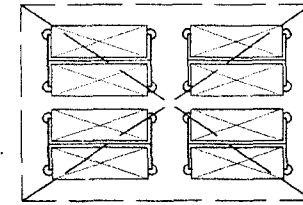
Вариант размещения стеллажей (этажерок) под вытяжным зонтом
